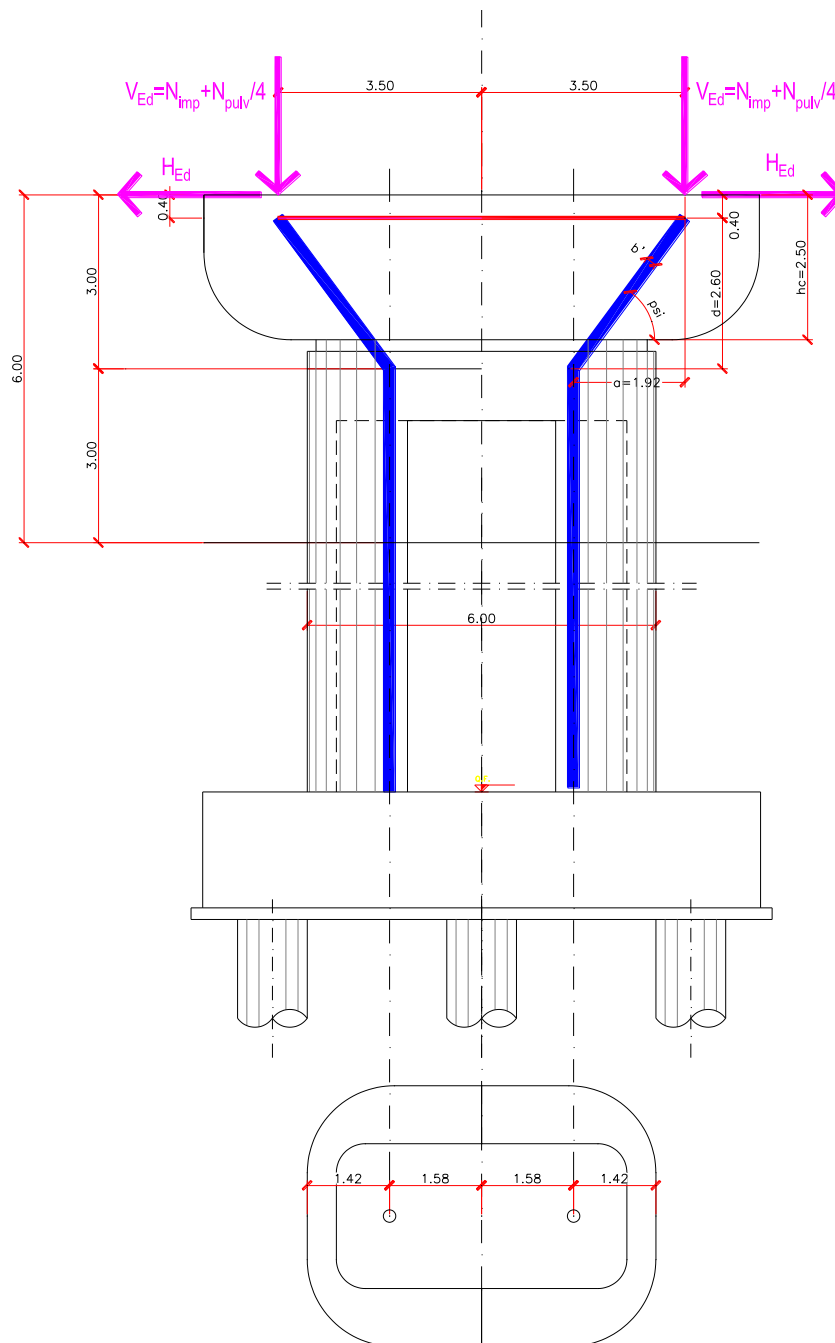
Schema statico per verifica pulvino – Pila-Spalla
